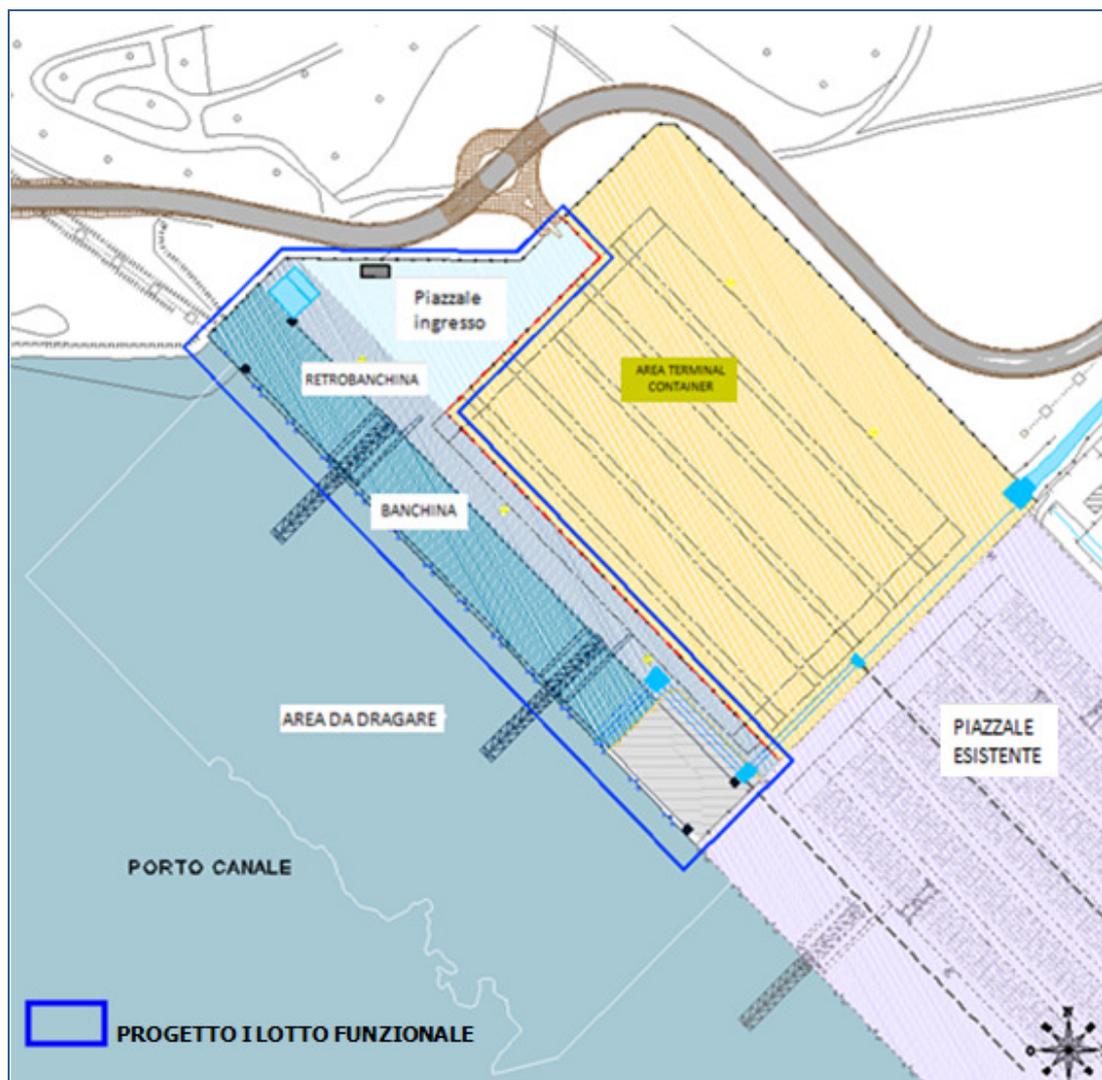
Stralcio della Tavola CABNE_QPGT_04 con la soluzione progettuale del primo lotto funzionale.
